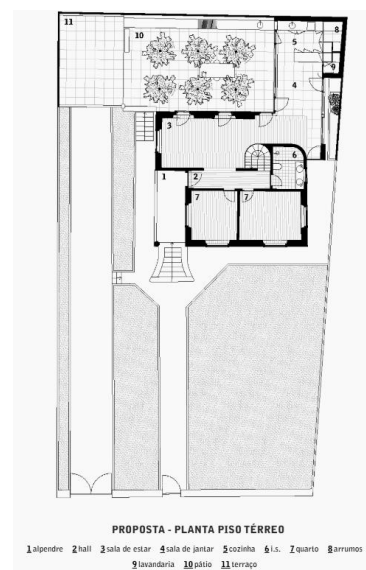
Planta do piso 0 proposta, Casa da Ericeira.
